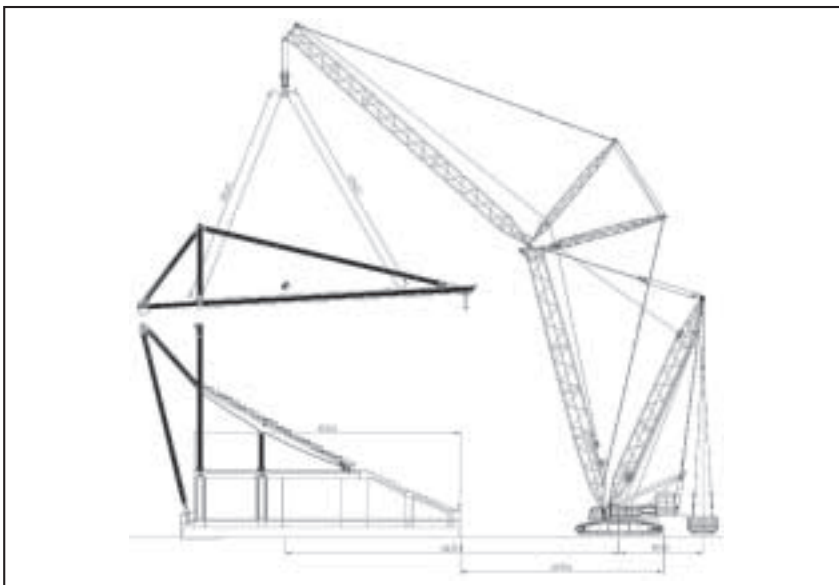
Metodo di montaggio delle macrostruttura di copertura
